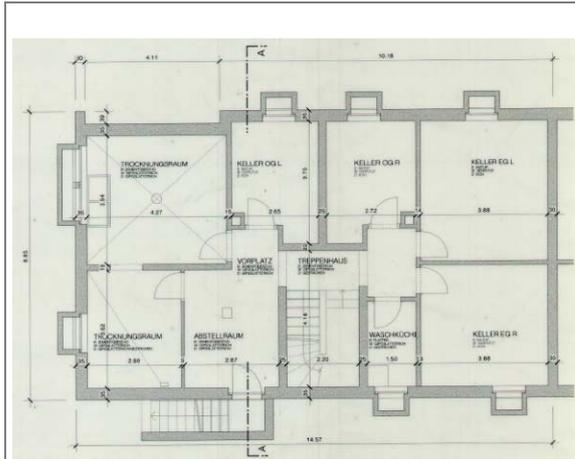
Grundriss UG [Quelle: Stadt Thun]⁴²
